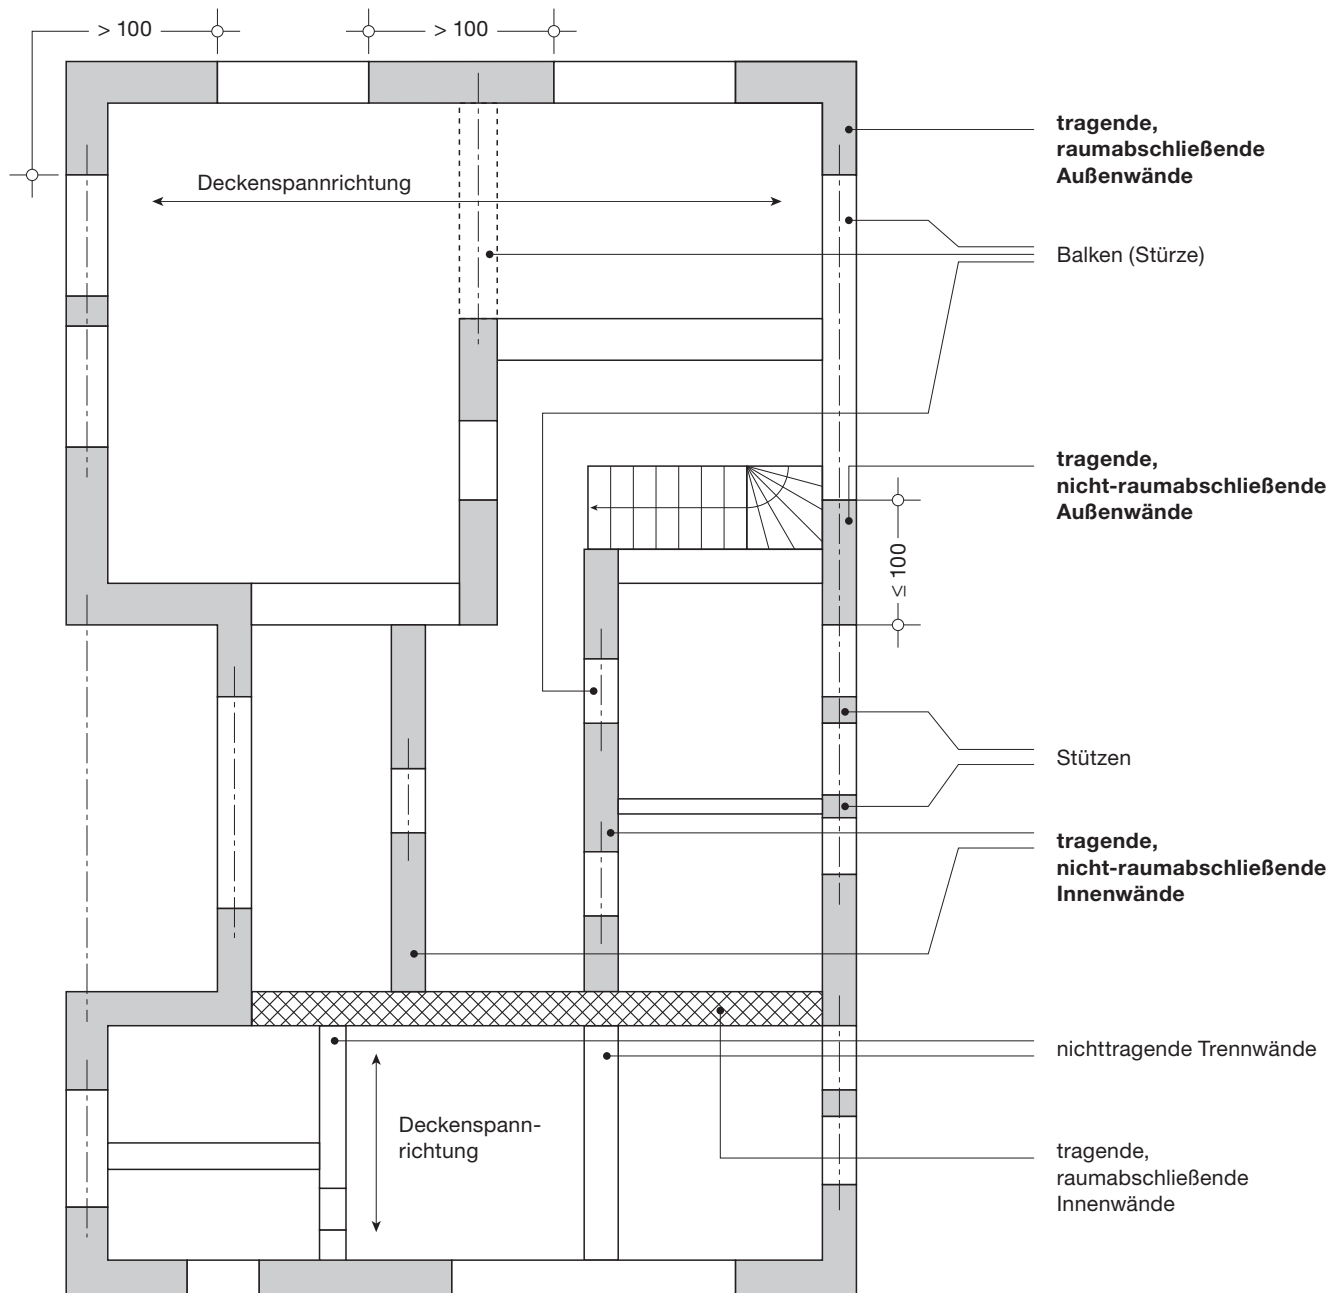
Schematischer Gebäudegrundriss mit Beispielen für die entsprechend DIN 4102-4 genannten Wandarten
